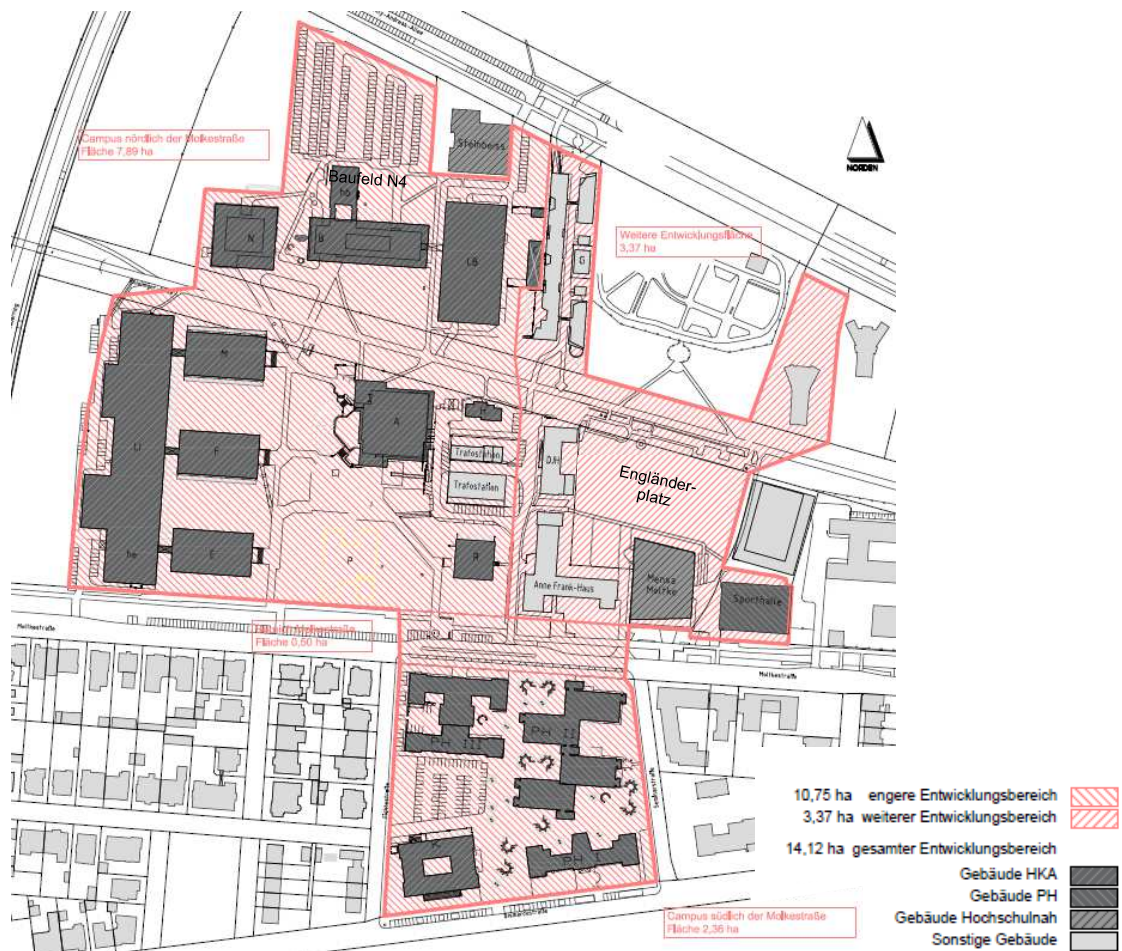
Betrachtungsraum siehe auch Anlagen Lageplan Betrachtungsraum M 1:2000
